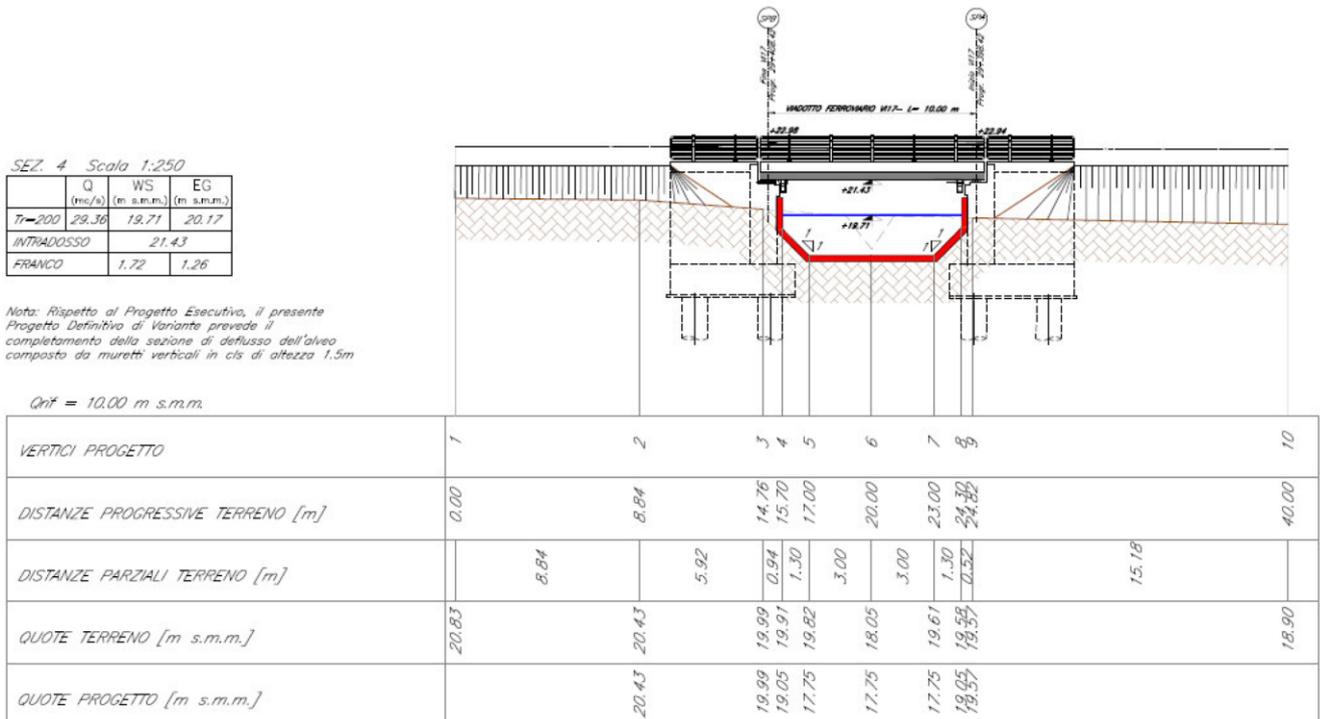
Sezione del Progetto esecutivo di modifica – stralcio RS39-10-V-ZZ-WA-ID1200-026
